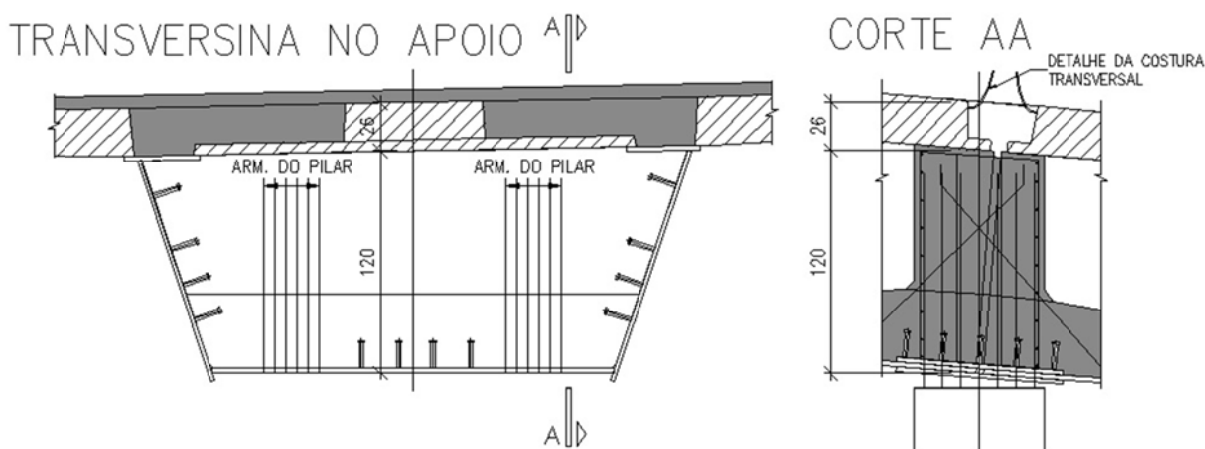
Travessa de concreto sobre pilares, dentro da seção caixaõ
